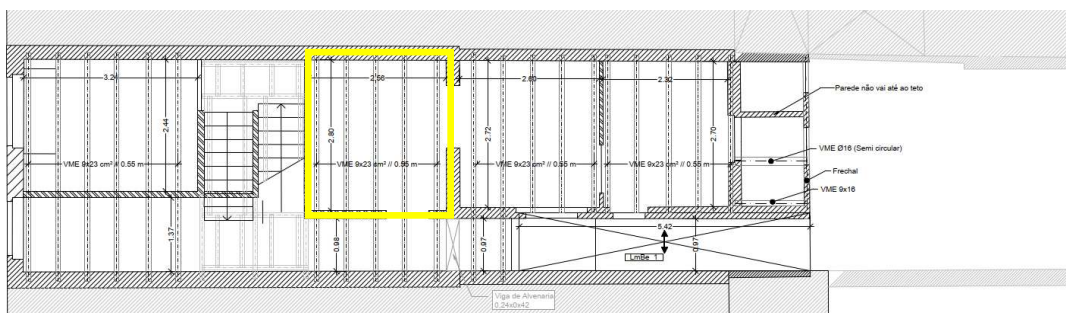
Pavimento com carga da parede de tabique do piso superior marcado a amarelo (Planta estrutural do piso 1)
